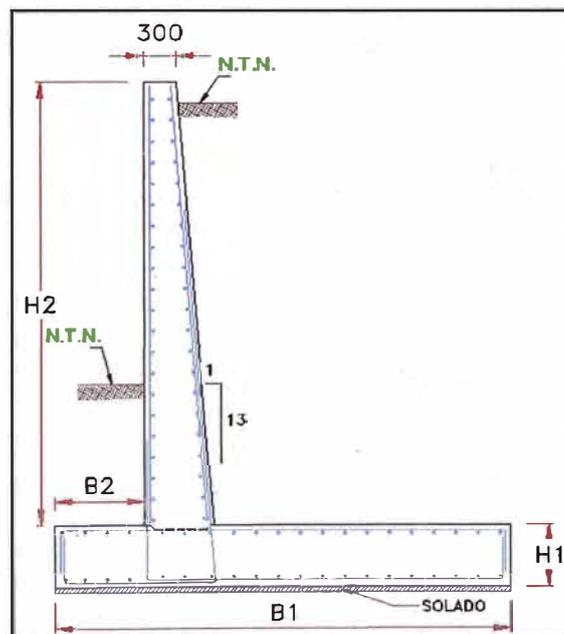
Sección típica del Muro de Contención de Concreto para cola de vía.
